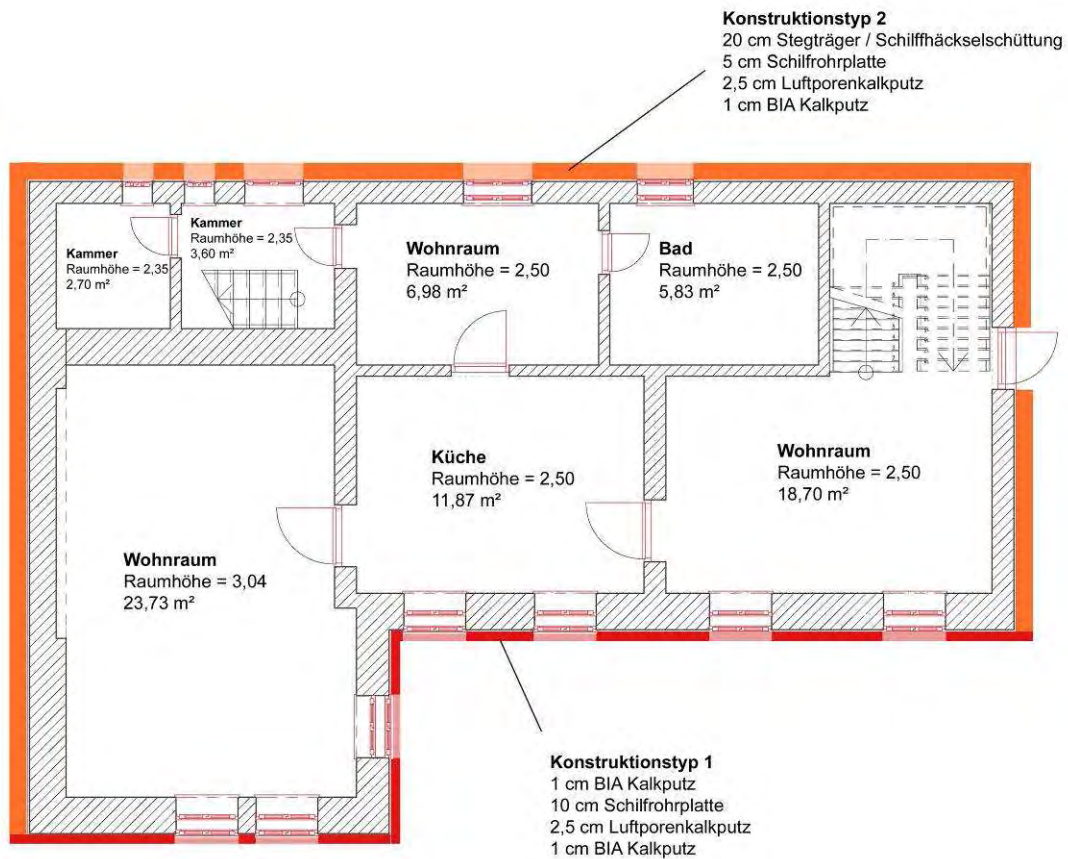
Grundrisschema EG für Sanierungsvariante „Außendämmung“
